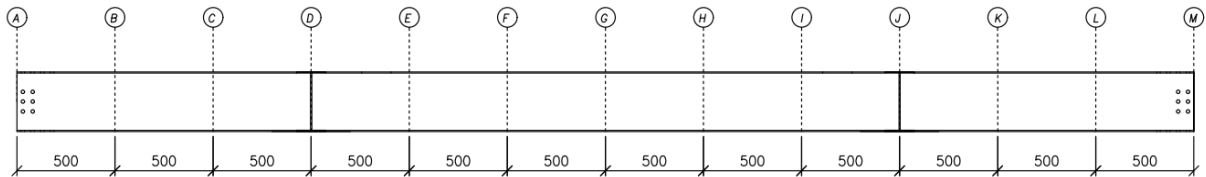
Posição das seções de medição de dimensões e imperfeições da viga.
